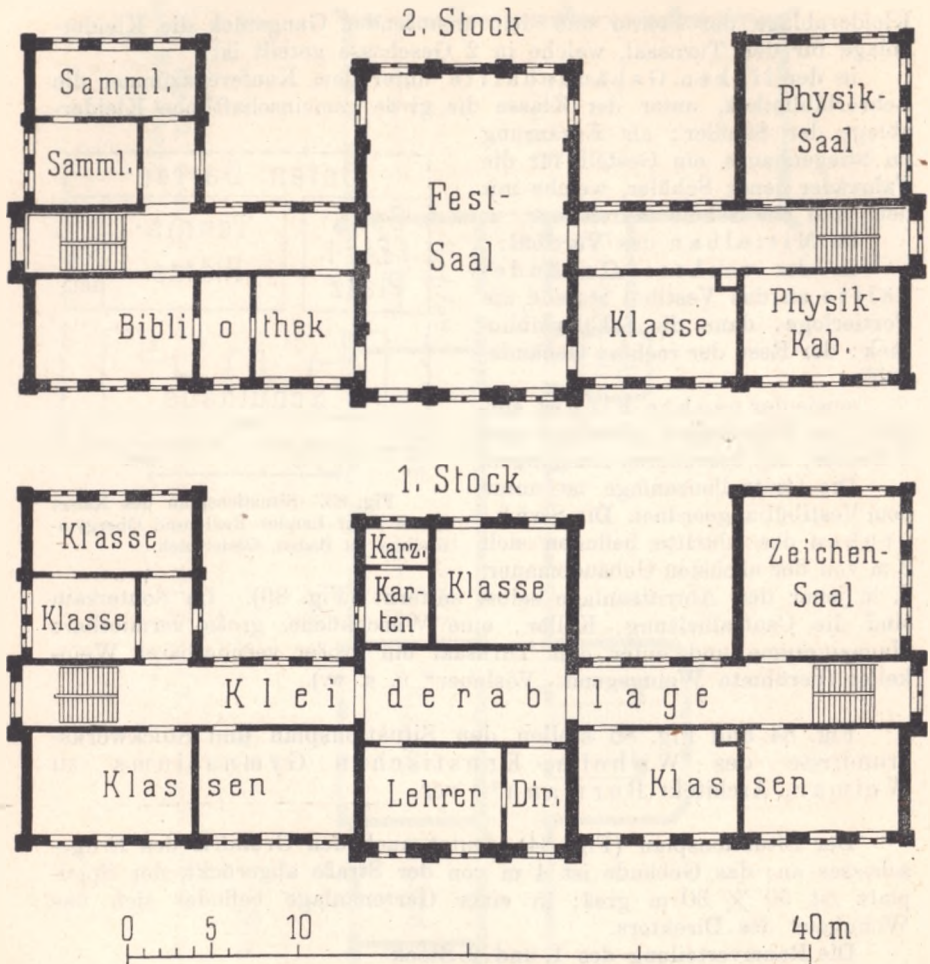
Grundriß des 1. und 2. Stockwerks zu voriger Figur.
